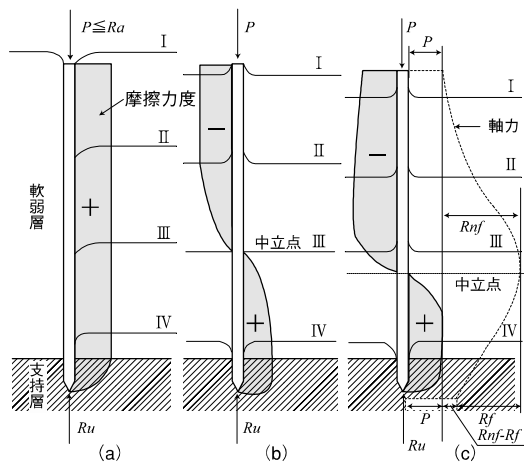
負の摩擦現象の説明図 [基礎地盤便覧 第2編 2-2]
